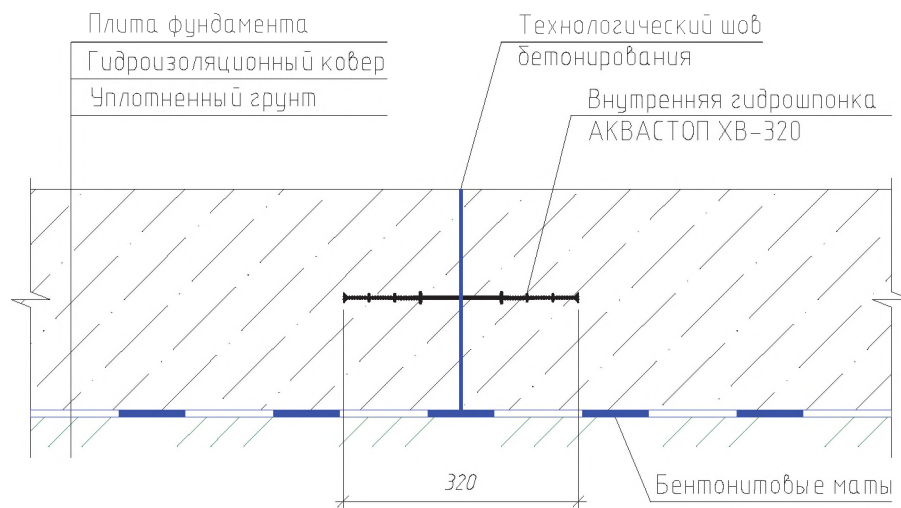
Гидроизоляция технологического шва бетонирования (вариант 2)
